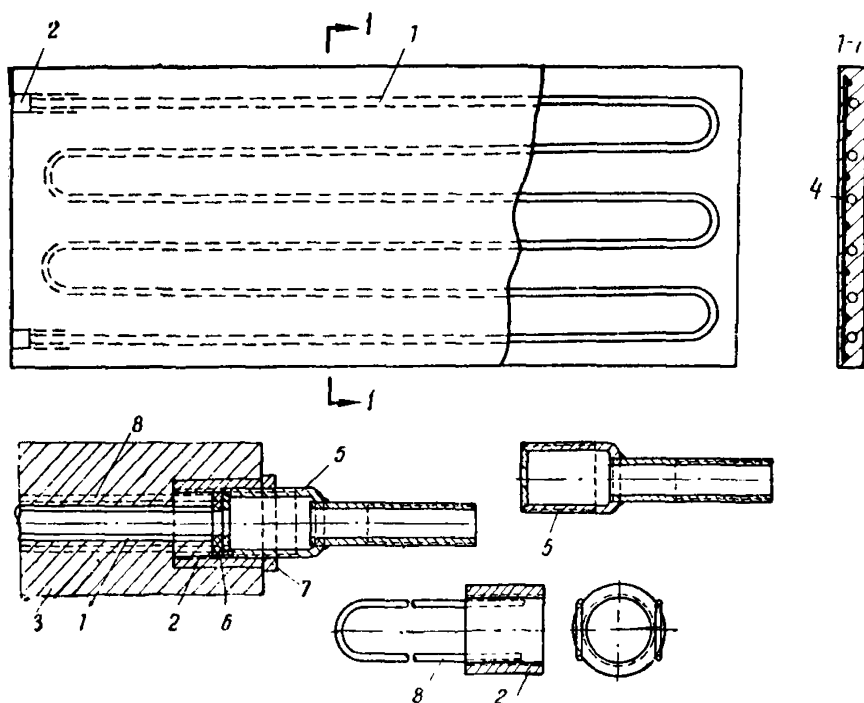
Конструкция стеклобетонной отопительной панели и узел соединения этой панели с подводками из стальных труб
